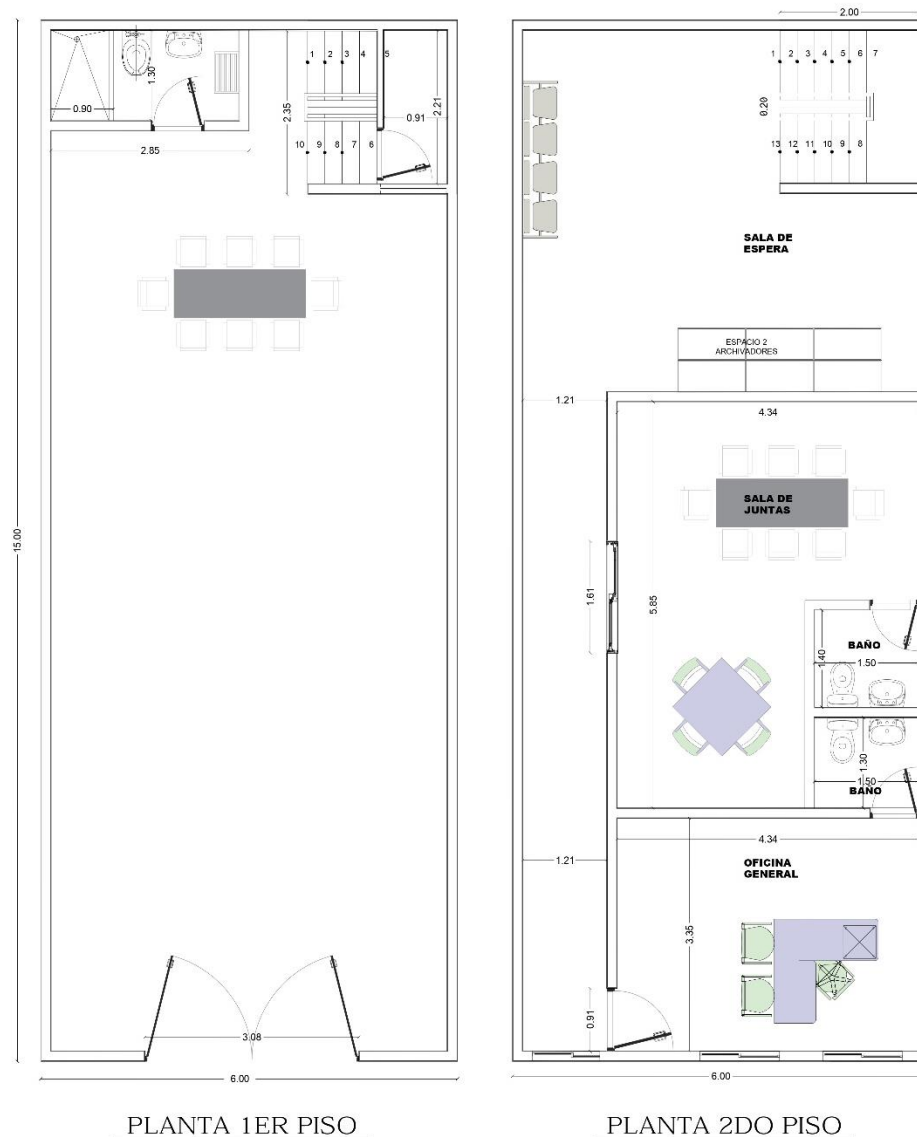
Bosquejo 2 vista en planta primer y segundo piso.
